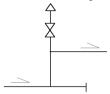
Установка арматуры для спуска воздуха и слива воды в точках перелома труб Для отключения отдельных частей системы отопления на последних устанавливают запорную арматуру, причем в тупиковых системах предпочтительной является схема изображенная на рис. 7.6, схема изображенная на
